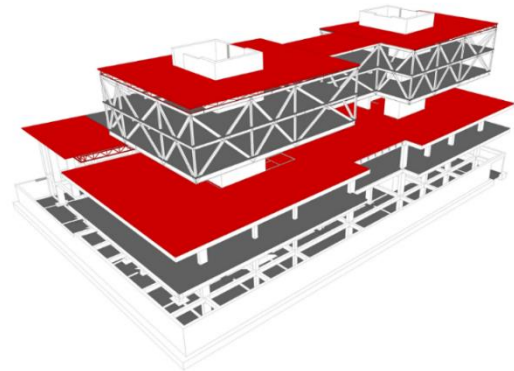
Axonometría - Sistema de Cubiertas Verdes y Transitables
